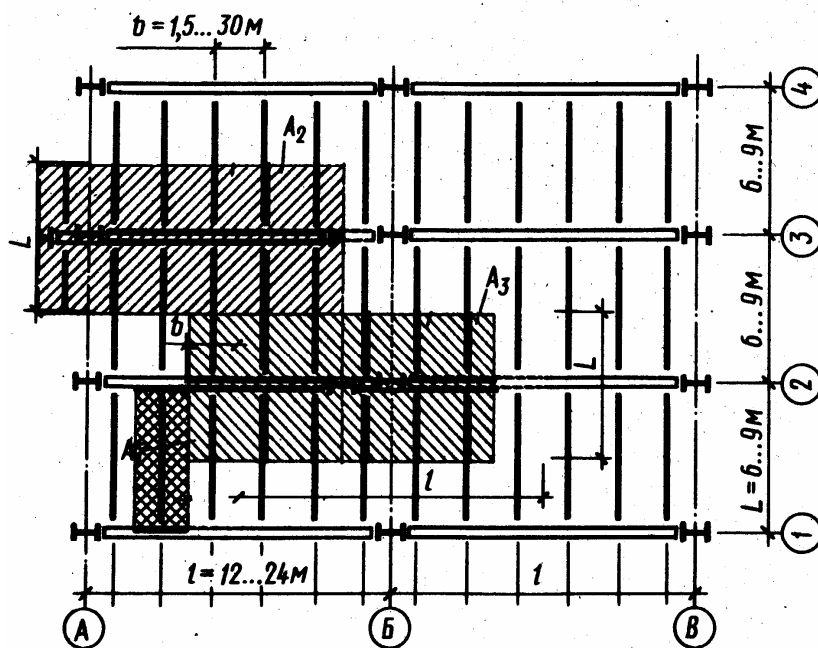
Определение грузовых площадей для основных элементов балочной клетки и колонны
